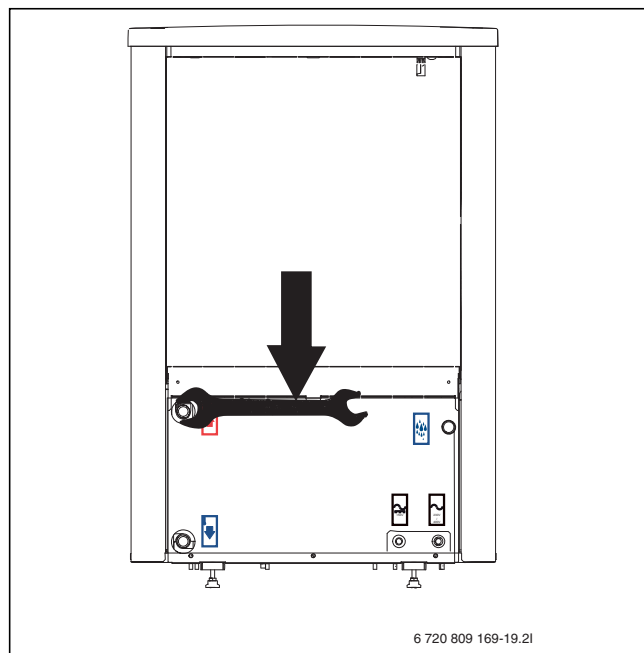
Serraggio attacchi pompa di calore. Serrare.
